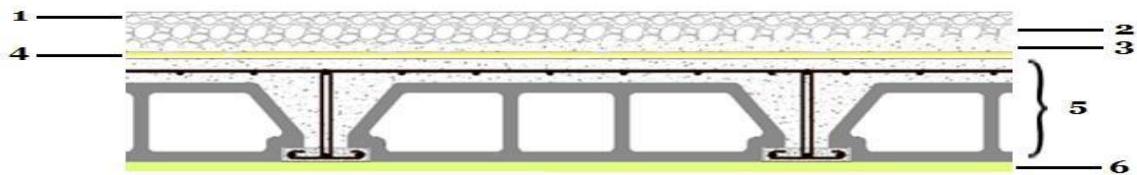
Coupe transversale d'un plancher terrasse inaccessible en ceps creux.
